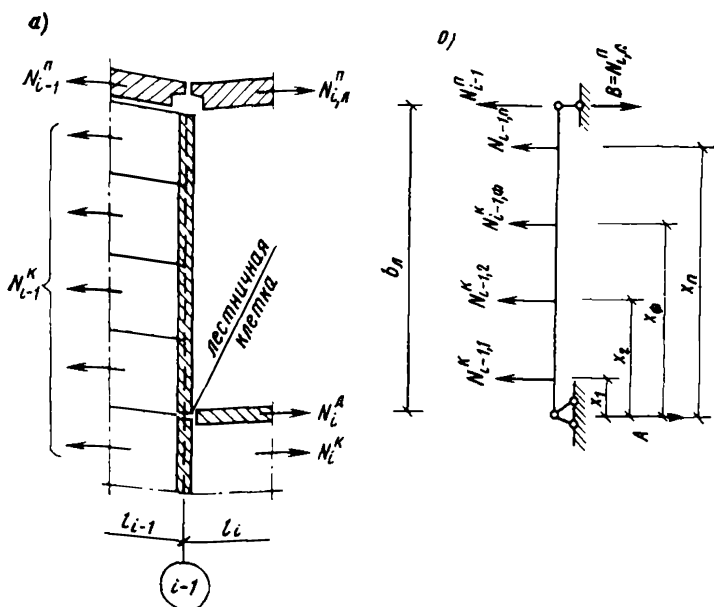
Температурные усилия в стенах и перекрытиях лестничной клетки:
